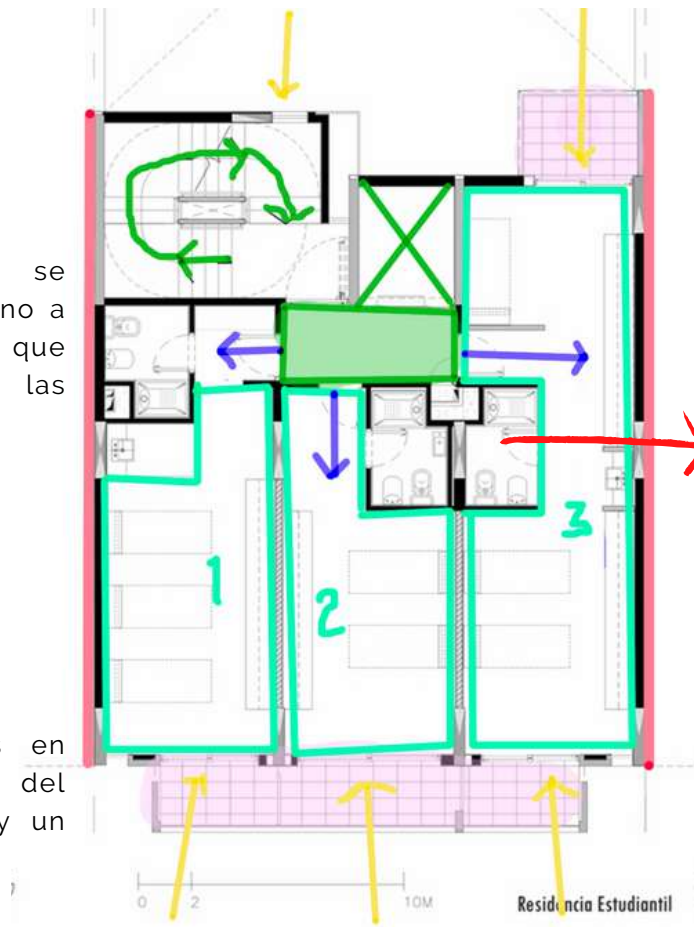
Planta arquitectónica intervenida con análisis.
